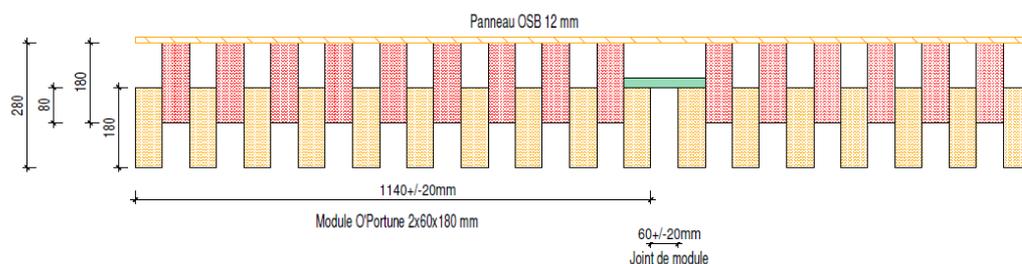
Dalle O'portune®, en planches vissées décalées, pour des portées de 6 m à 11 m
